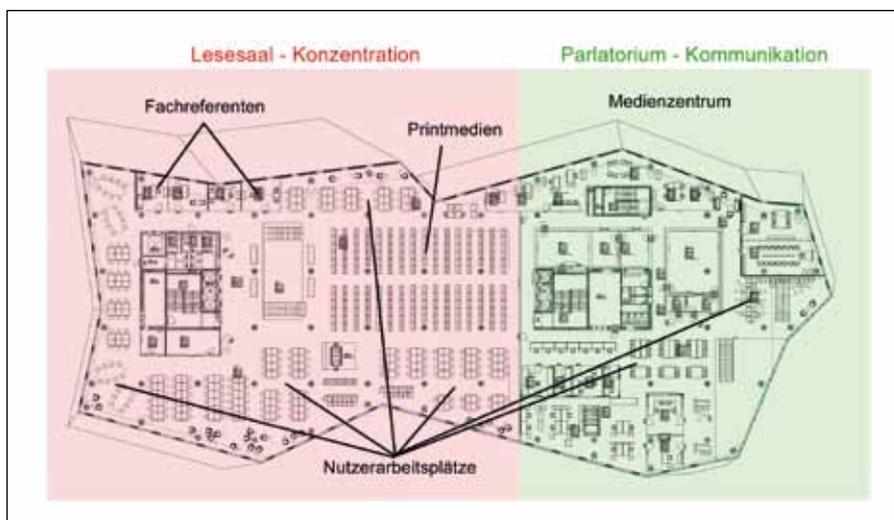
Grundriss 3. Obergeschoss
